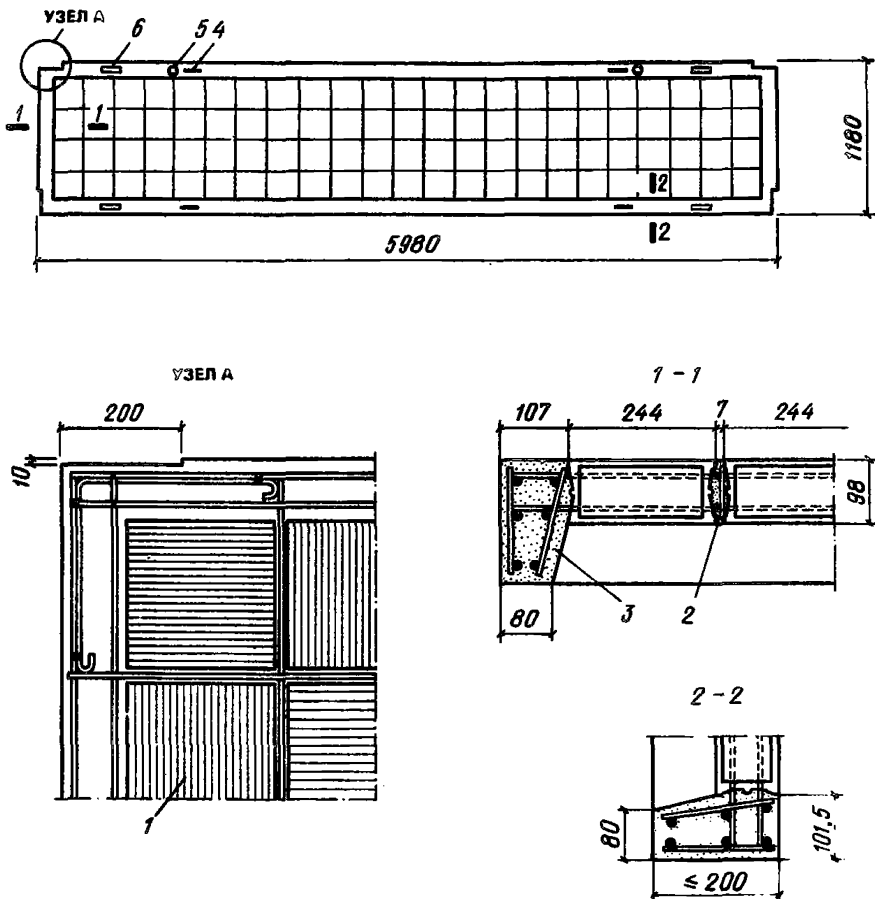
Стекложелезобетонная вертикальная навесная панель из стеклоблоков БК 244/98 с обвязкой, утолщенной по всему периметру
